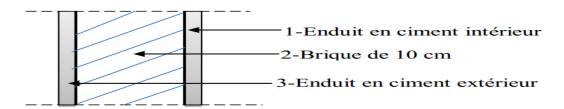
Coupe transversale des murs intérieurs (type 1).
